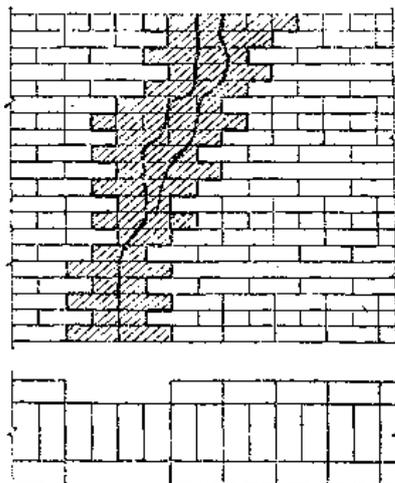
Заделка трещин с разборкой старой кладки
